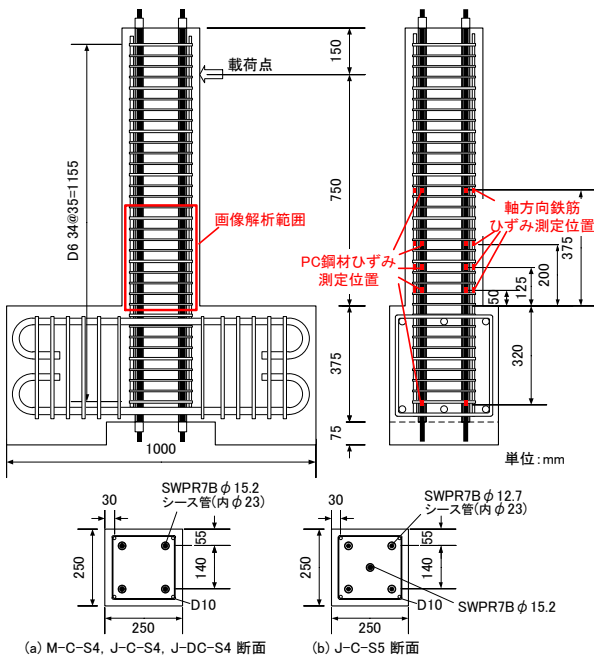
供試体配筋図 (側面図はM-C-S4 供試体)
